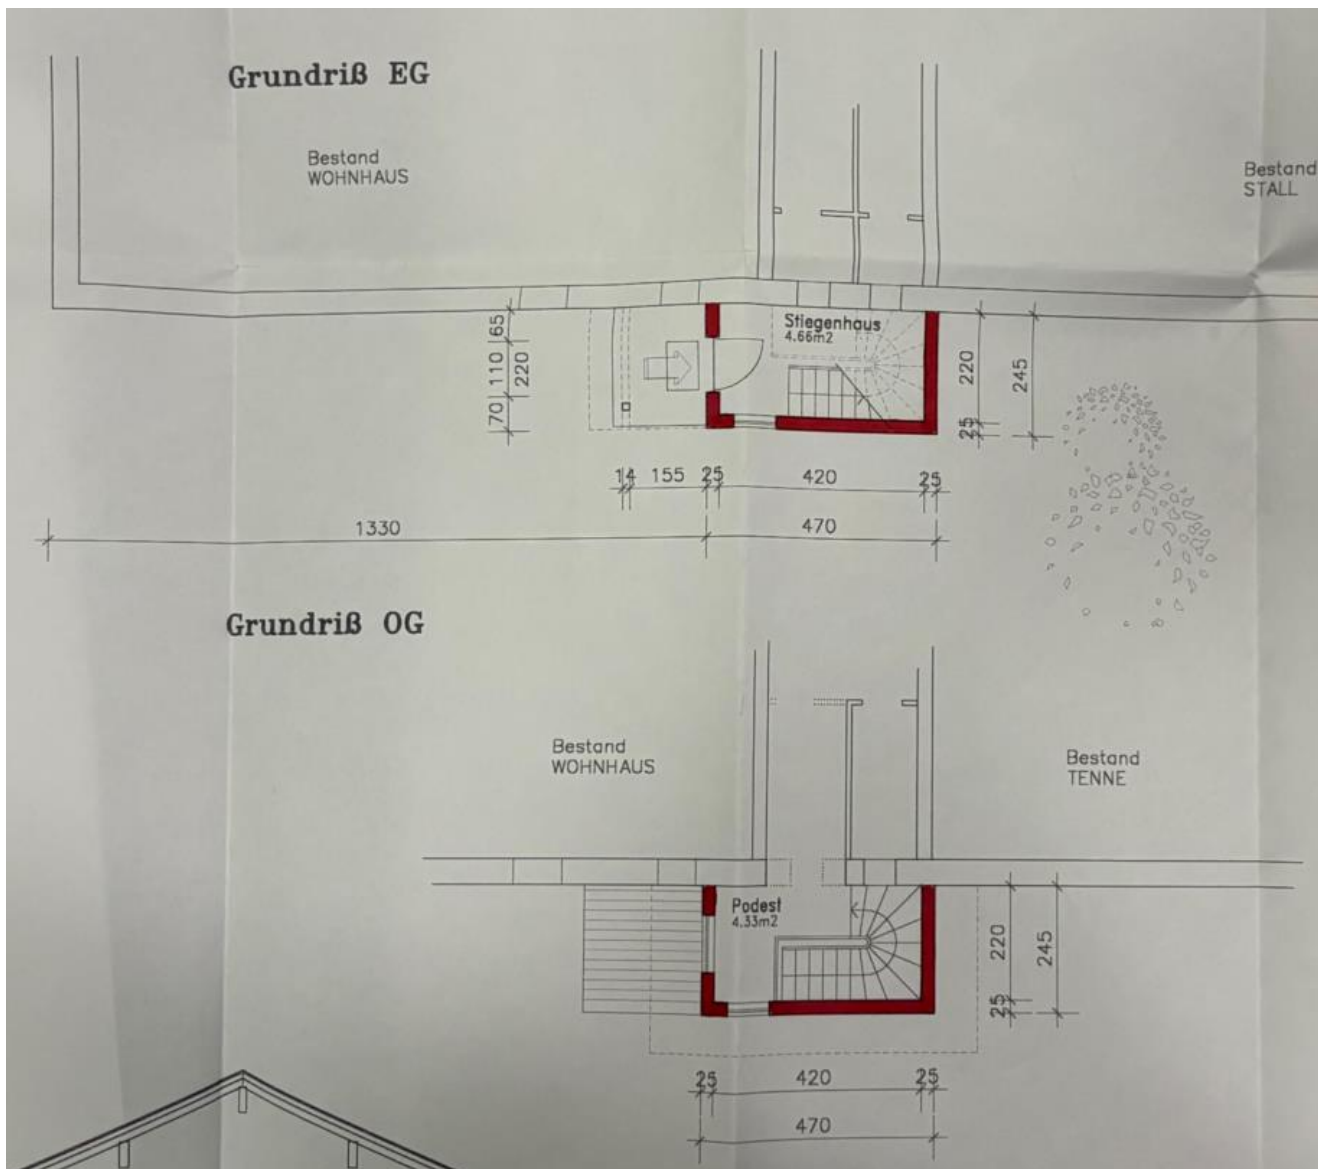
Grundriss Stiegenhaus Anbau (1997)
